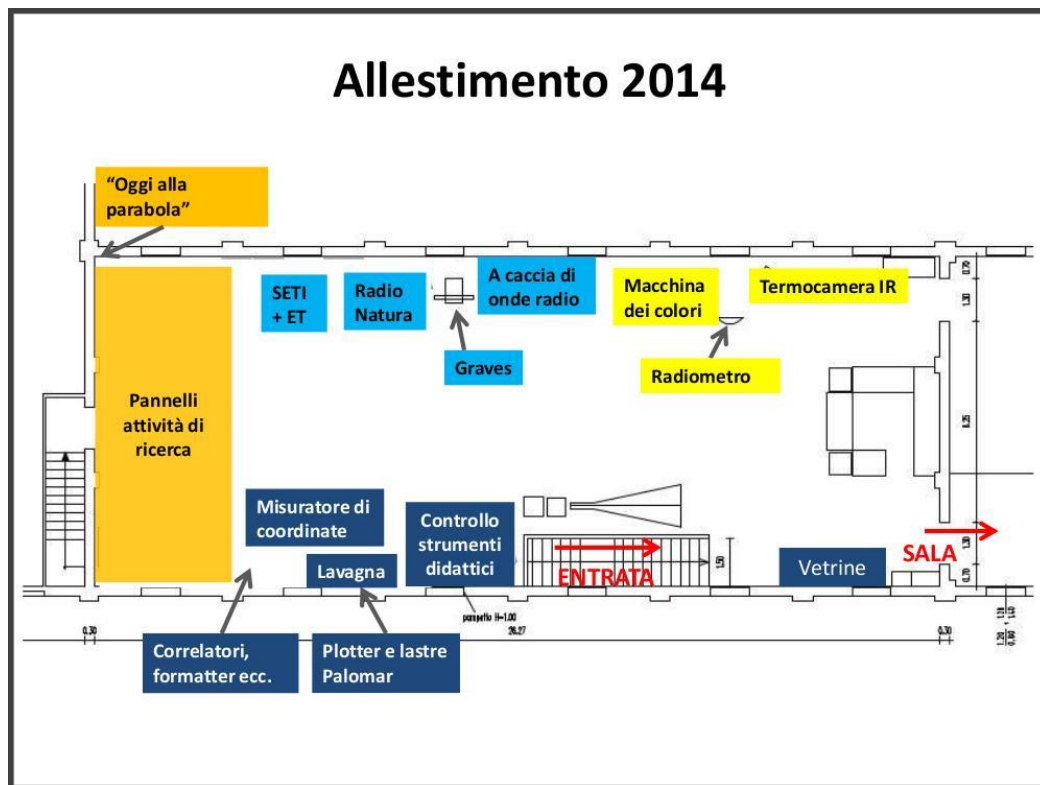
Schema in pianta dall'alto del nuovo allestimento del 2014.
